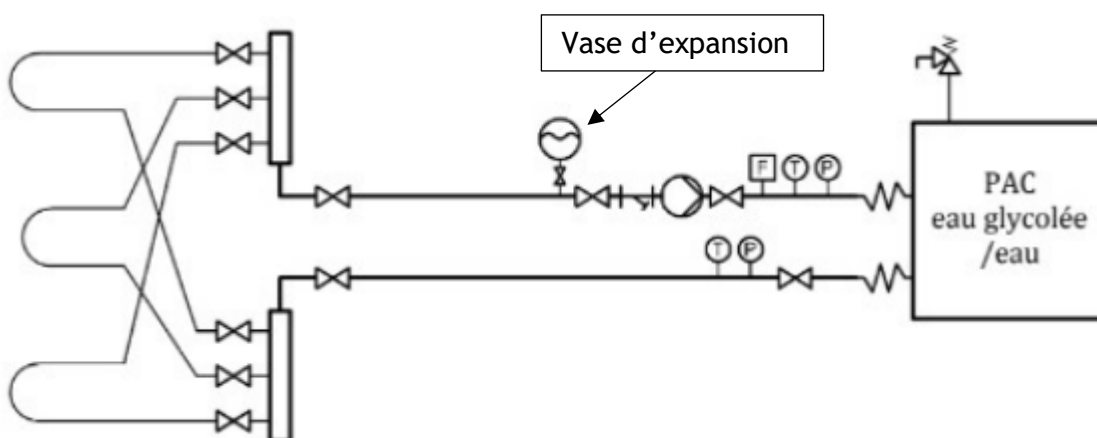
Schéma de principe d'une installation sur sondes - source DTU65.16
